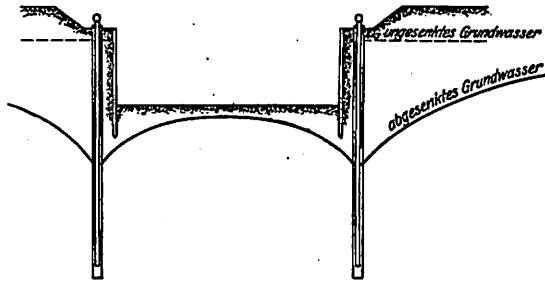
Baugrubentrockenlegung durch Grundwasserabsenkung.
